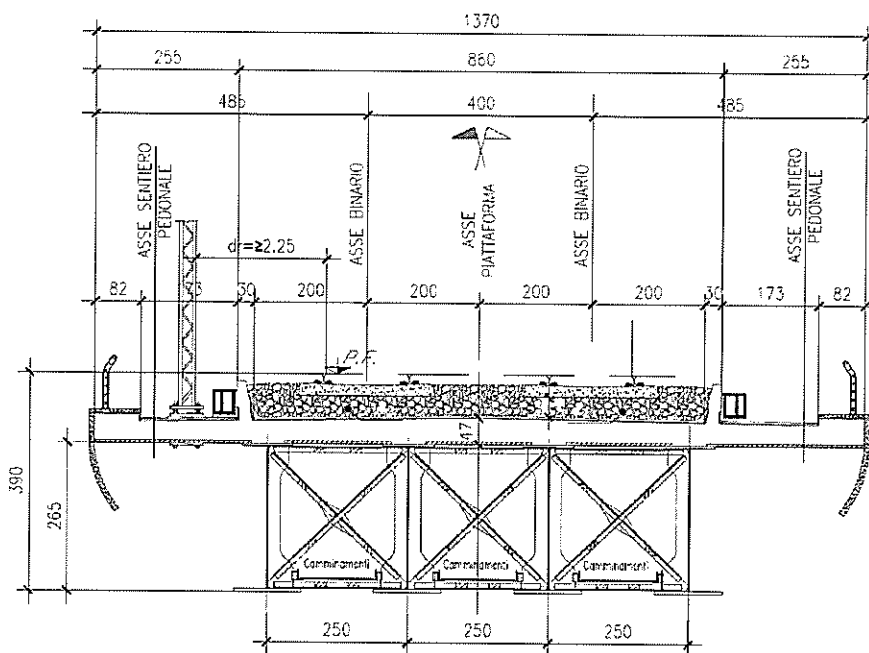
Impalcato in acciaio - cls L = 40 m: sezione trasversale
